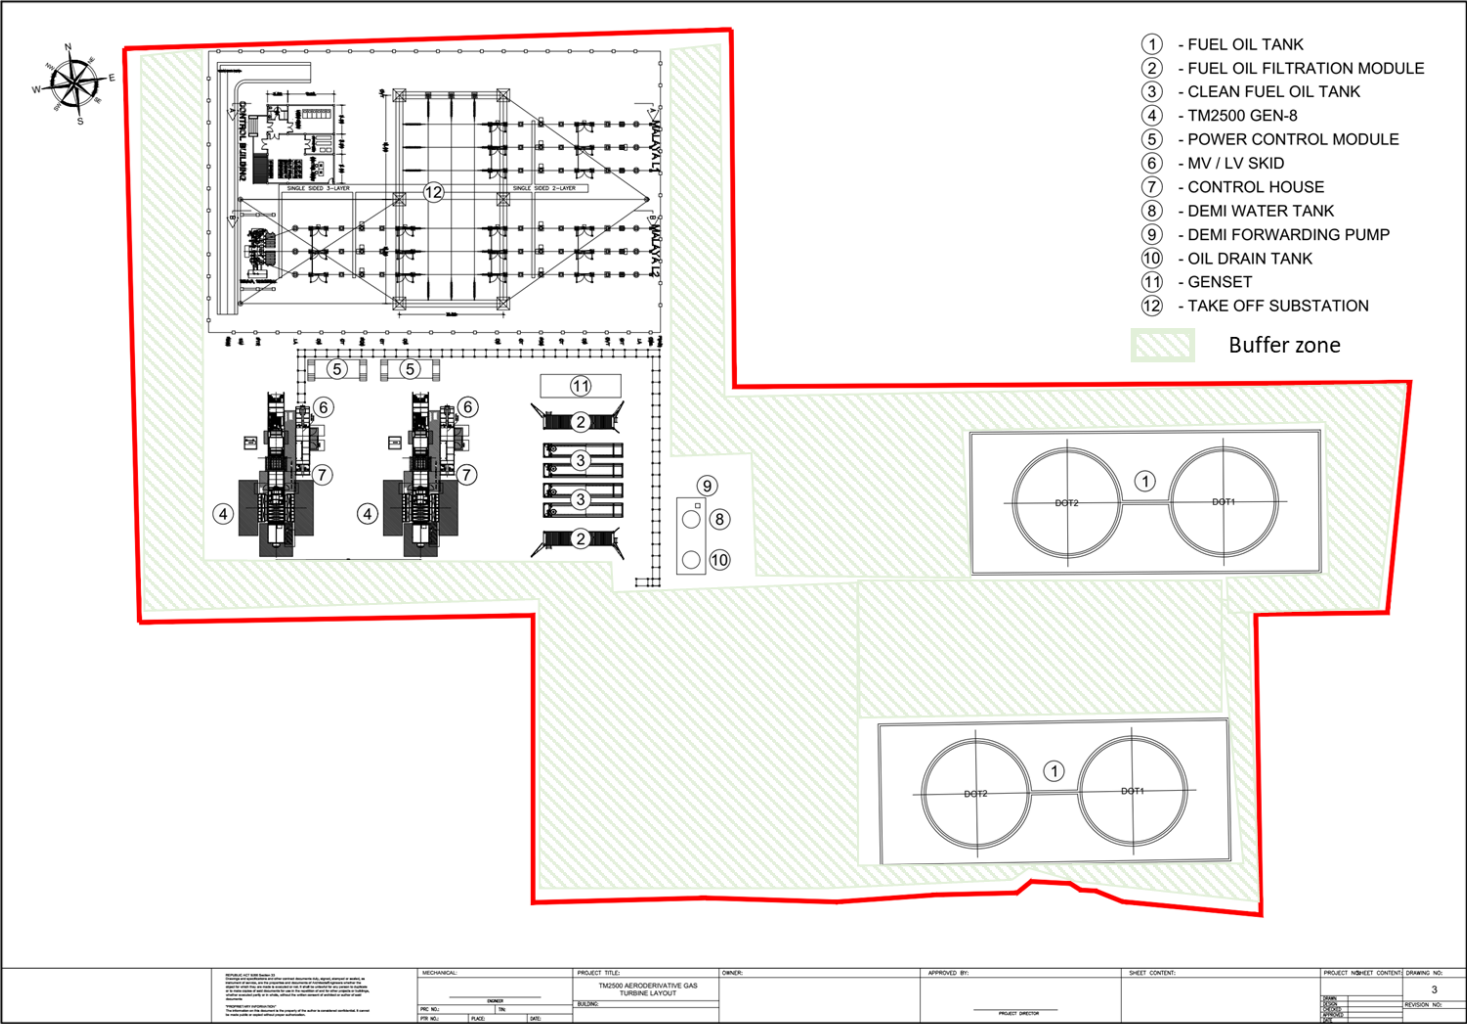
Iminumungkahing Plant Layout ng Proyekto
